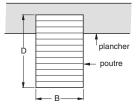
b) Dimensions des poutres et poteaux lamellés-collés
